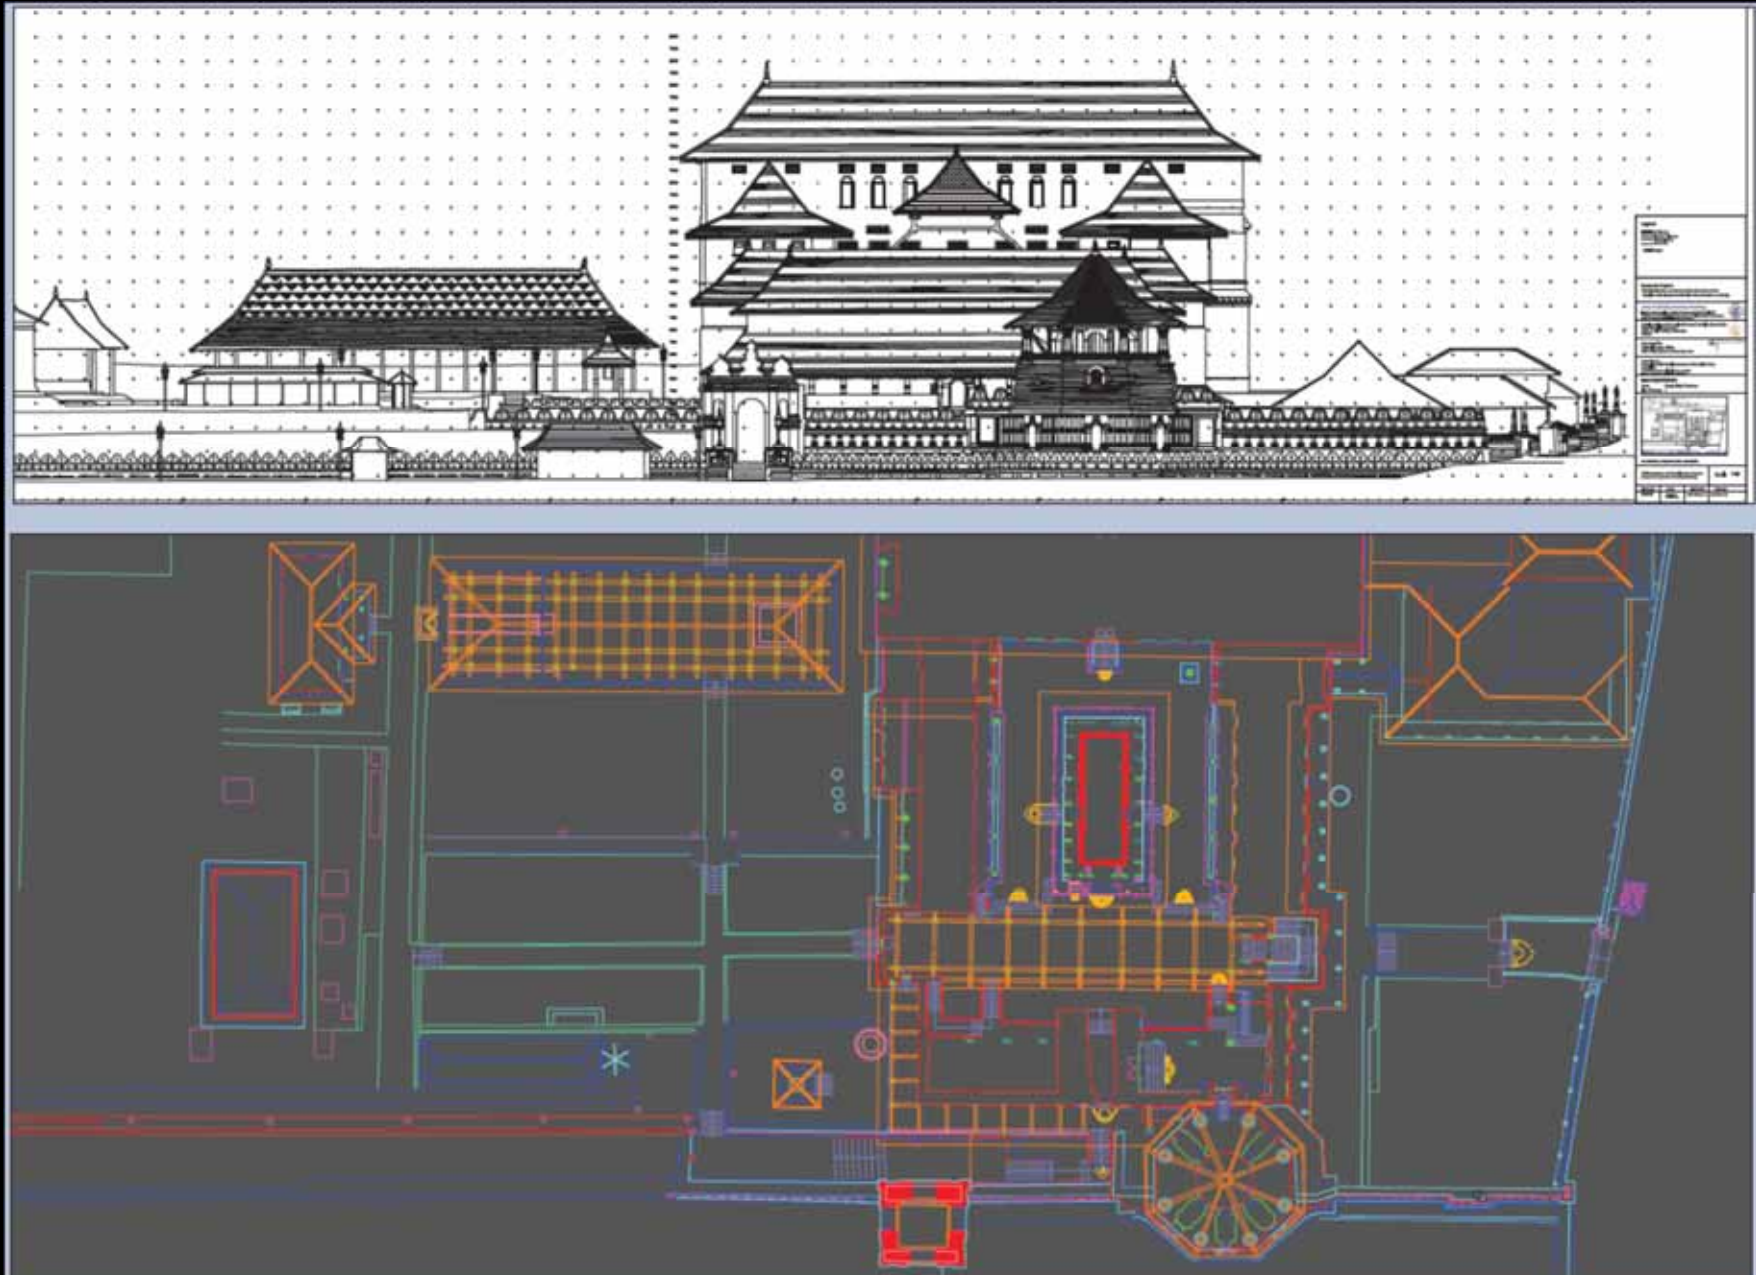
Fassadenansicht (oben) und Grundriss (unten) durch die Tempelanlage (Luib/Rahrig, 2016)
